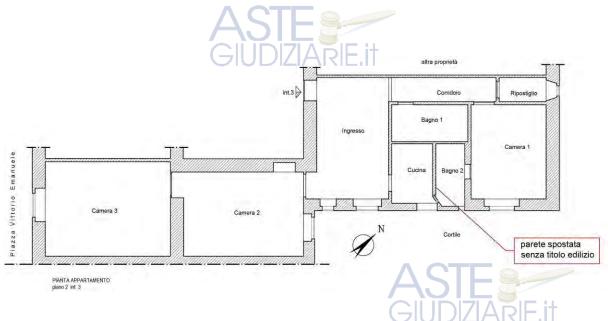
Planimetria del bene al piano secondo, oggetto di pignoramento
